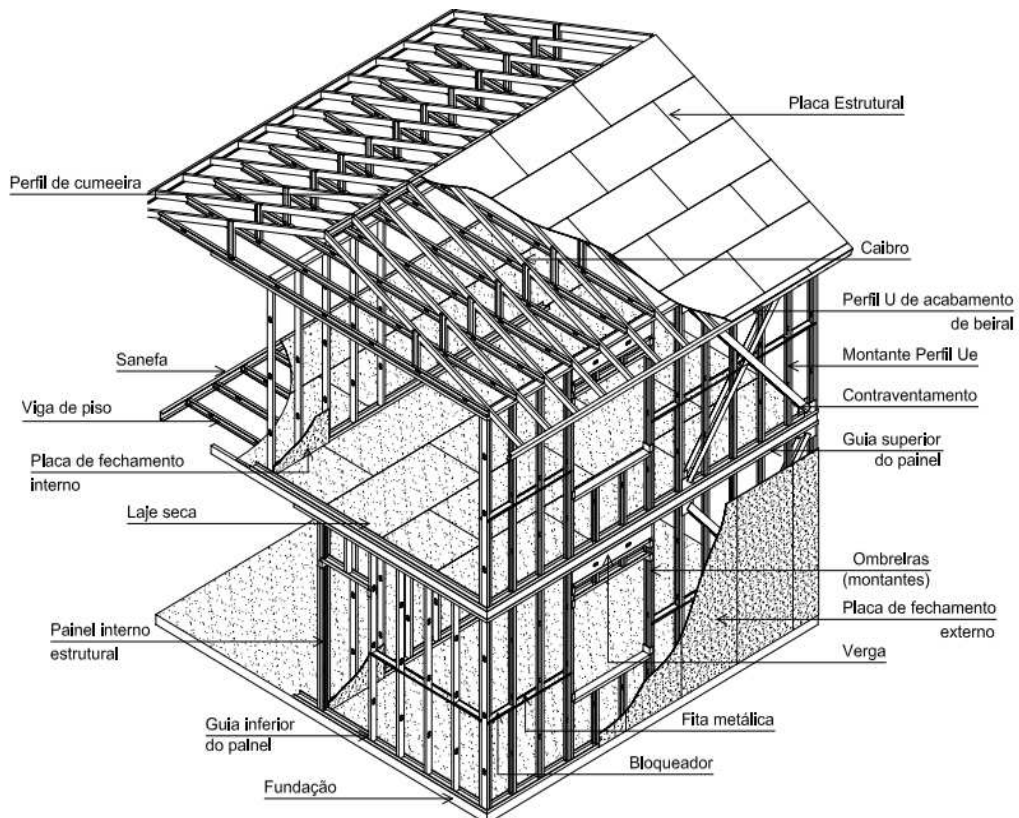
Elementos construtivos principais de uma edificação em LSF (Adaptado de Santiago et al., 2012 [7])
